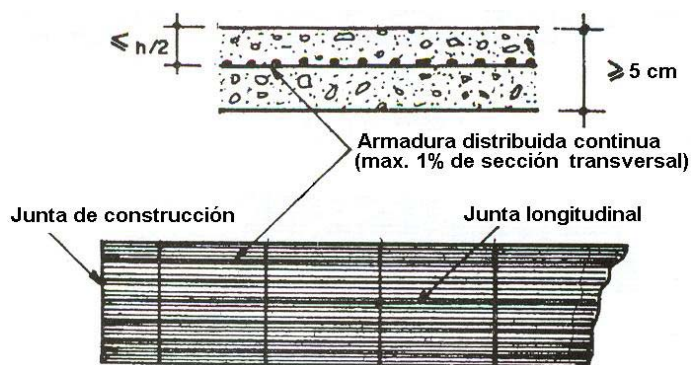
Pavimento de Concreto con Refuerzo de Acero Continuo.
